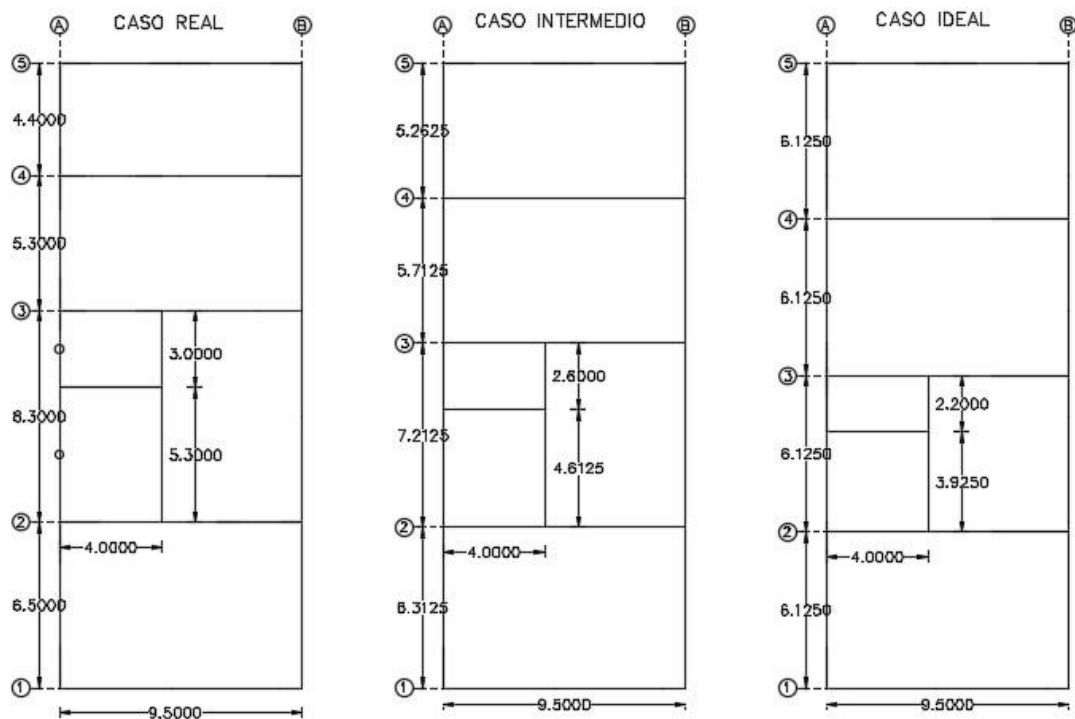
Vista en planta de los casos de estudio en función del espaciamiento entre los muros interiores
